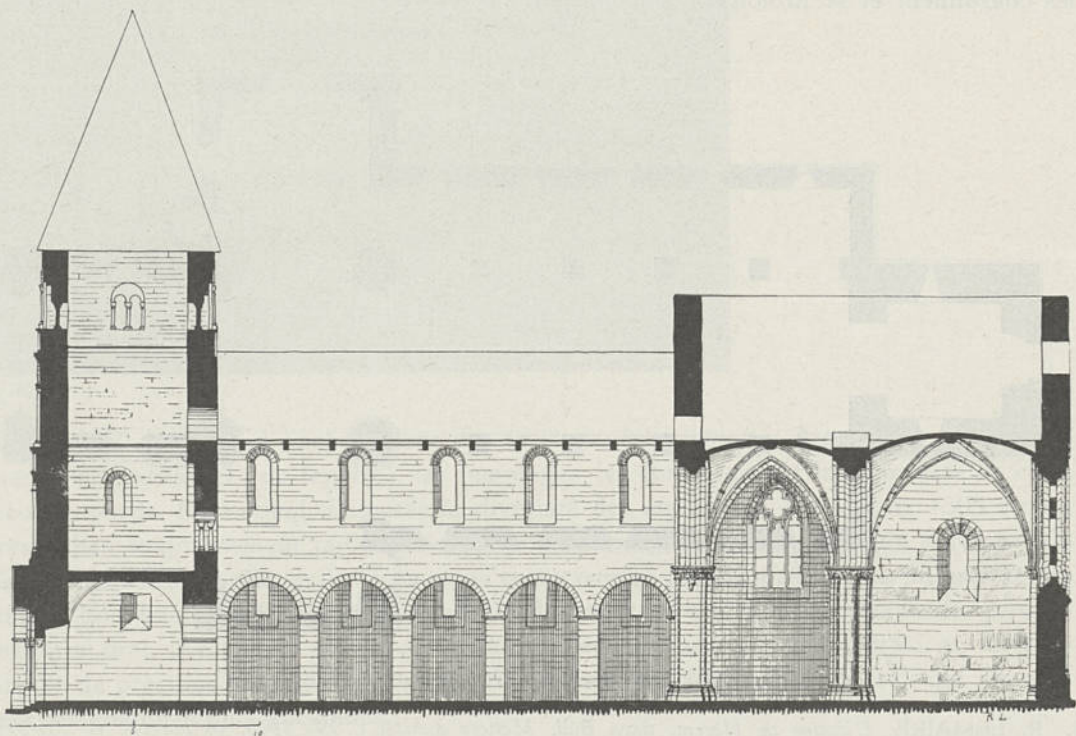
Herent, Eglise Notre-Dame, coupe longitudinale, reconstitution
